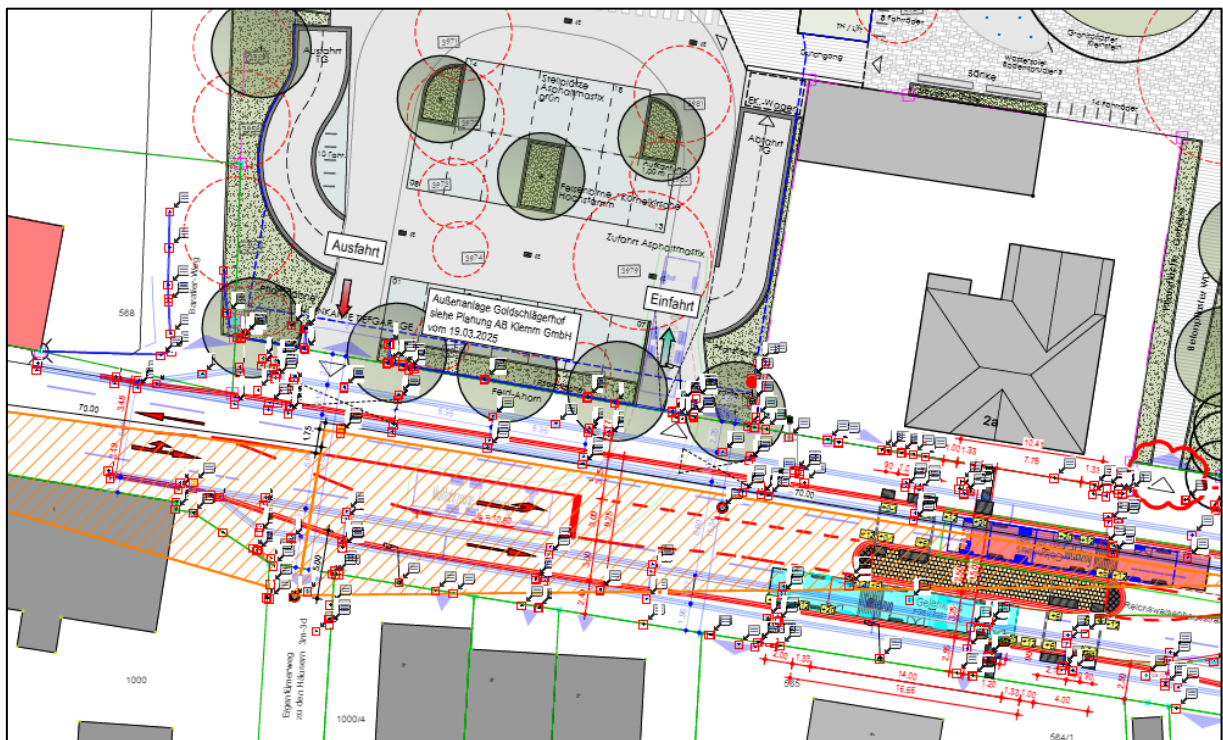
Lageplan Erschließung Goldschlägerhof<sup>1</sup>
